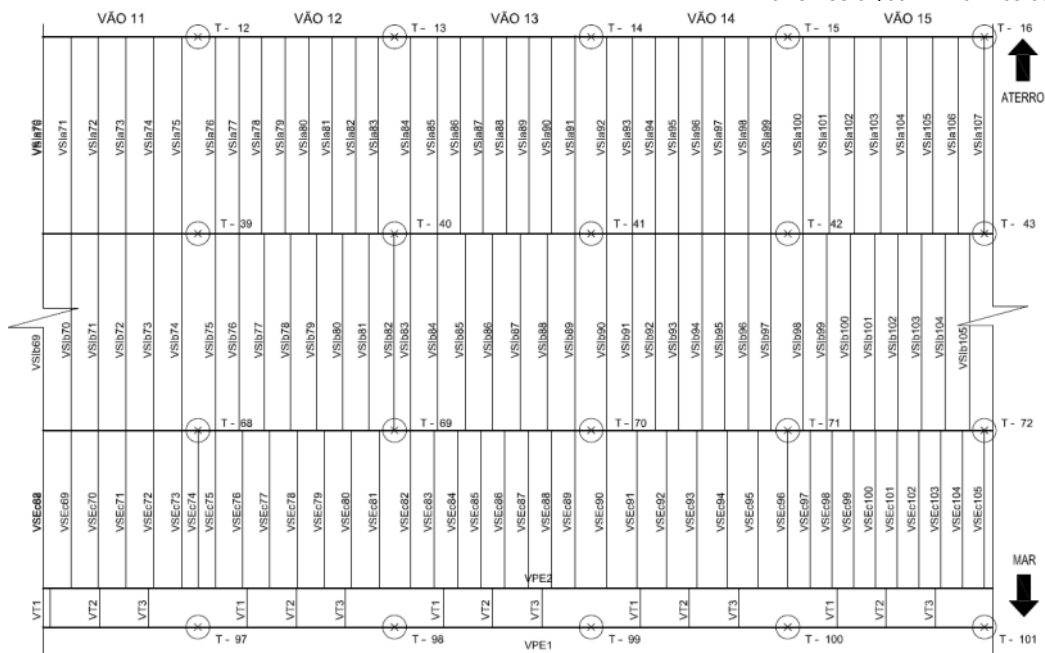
Planta do Berço 103 entre Vãos 11 e 15
